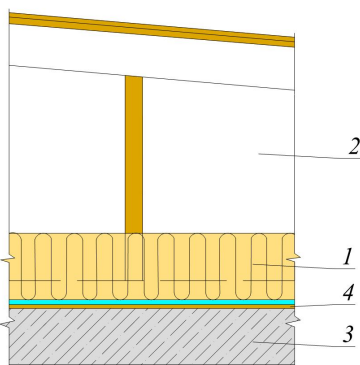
Конструкция ж/б чердачного перекрытия: 1 – тепловая изоляция; 2 – чердачное помещение; 3 – ж/б плита перекрытия; 4 – пароизоляция
